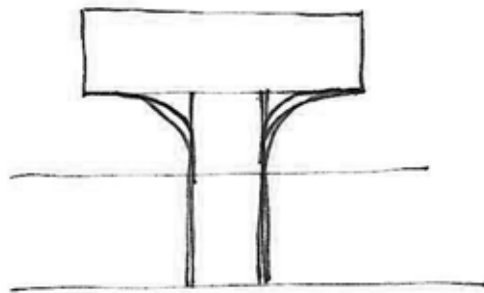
Esquisso esquemático da estrutura do restaurante.
